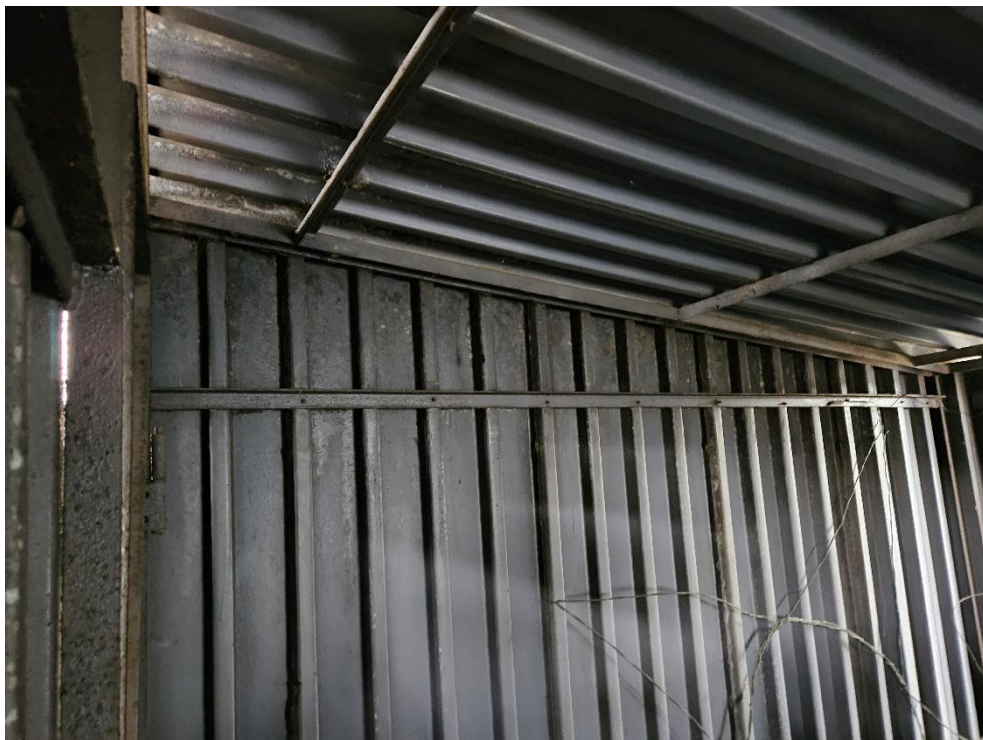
Stan konstrukcji ramowej nad dzwonem Langena
